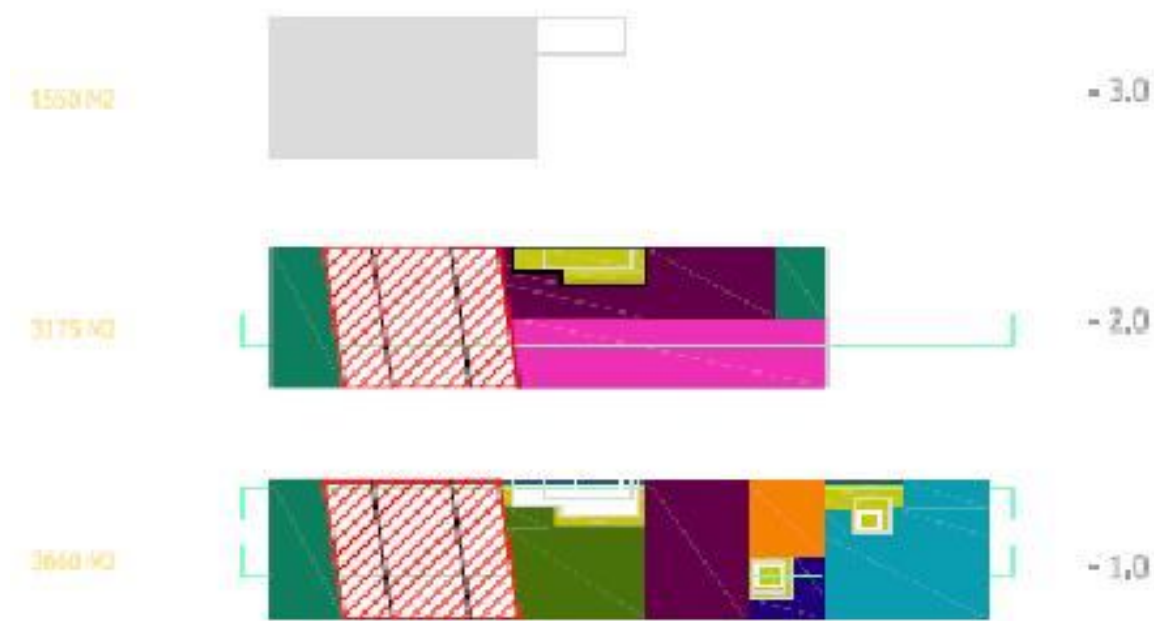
Particolare della distribuzione funzionale degli spazi in pianta
